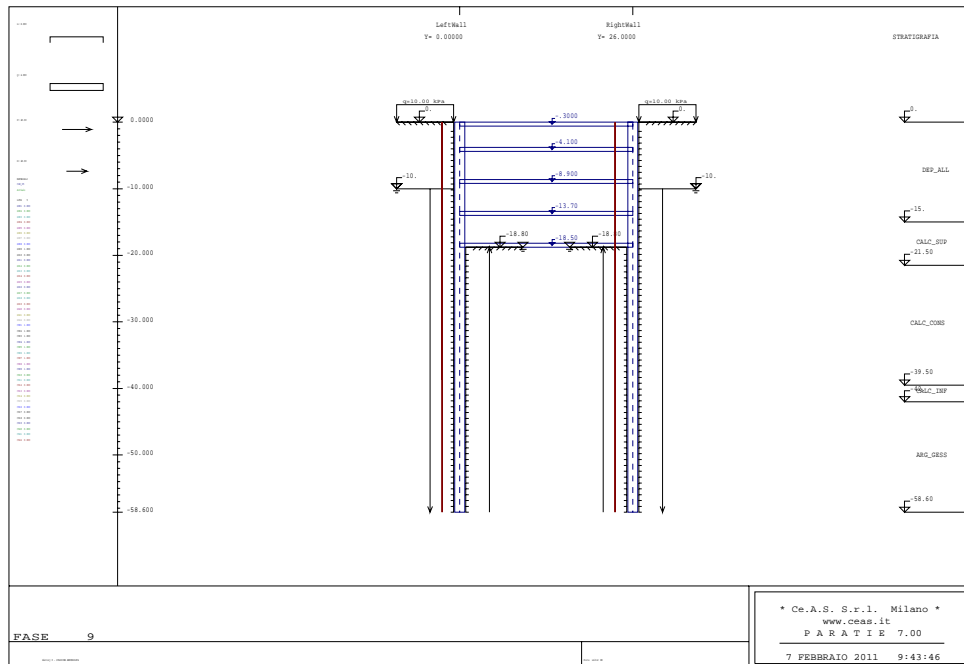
Fase 9: Getto solaio a +49.11m s.l.m.
